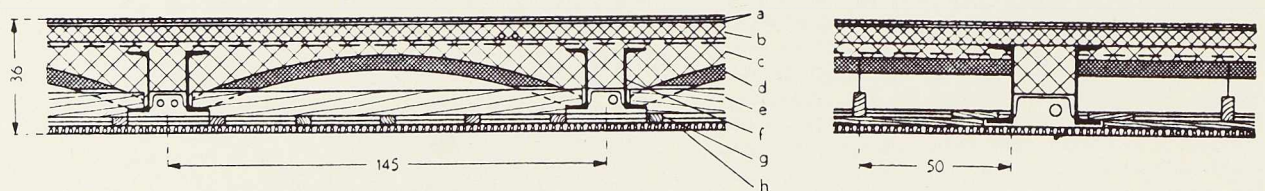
Plancher avec solives en bois. Coupes longitudinale et transversale :
